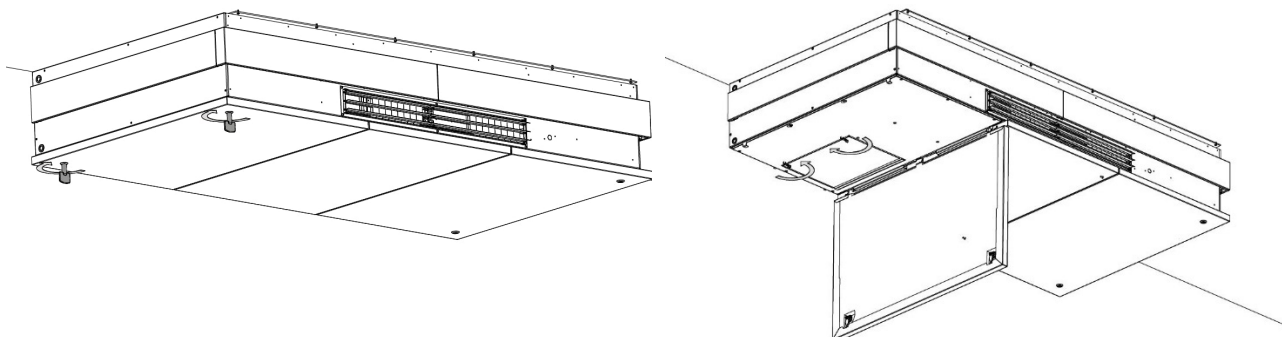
Ouvrir la plaque de fond et la trappe du filtre
